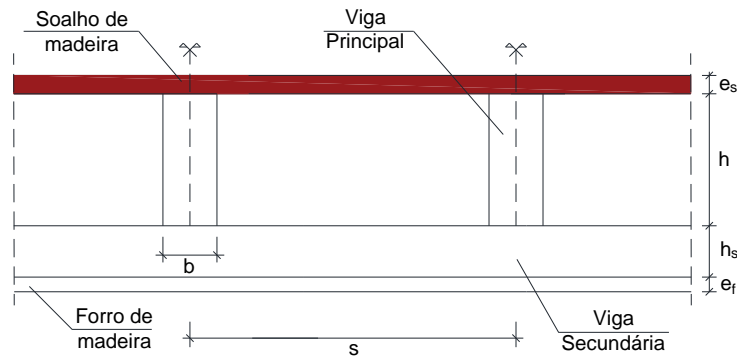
Secção média dos elementos de madeira que compõem parte do pavimento 3 (Pav. 3 – S1.3)
